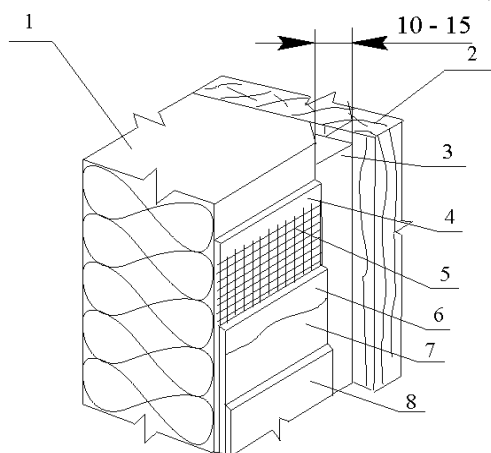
Фрагмент соединения плиты утеплителя с оконной рамой. 1 - плитный утеплитель; 2 - деревянный блок; 3 - герметизирующий материал Ceresit Akрил; 4 - первый слой гидрозащитного штукатурного раствора; 5 - стеклосетка; 6 - второй слой гидрозащитного штукатурного раствора; 7 - грунтовка; 8 - защитно-отделочный раствор.
